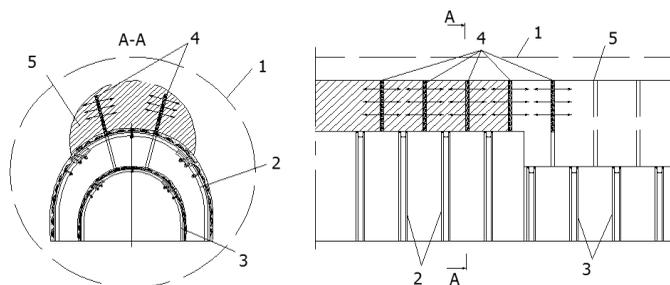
Способ перекрепления выработки: 1 – зона разрушенных пород; 2 – новая крепь; 3 – старая крепь; 4 – скважины для создания распора в породах; 5 – зона возможного обрушения пород
